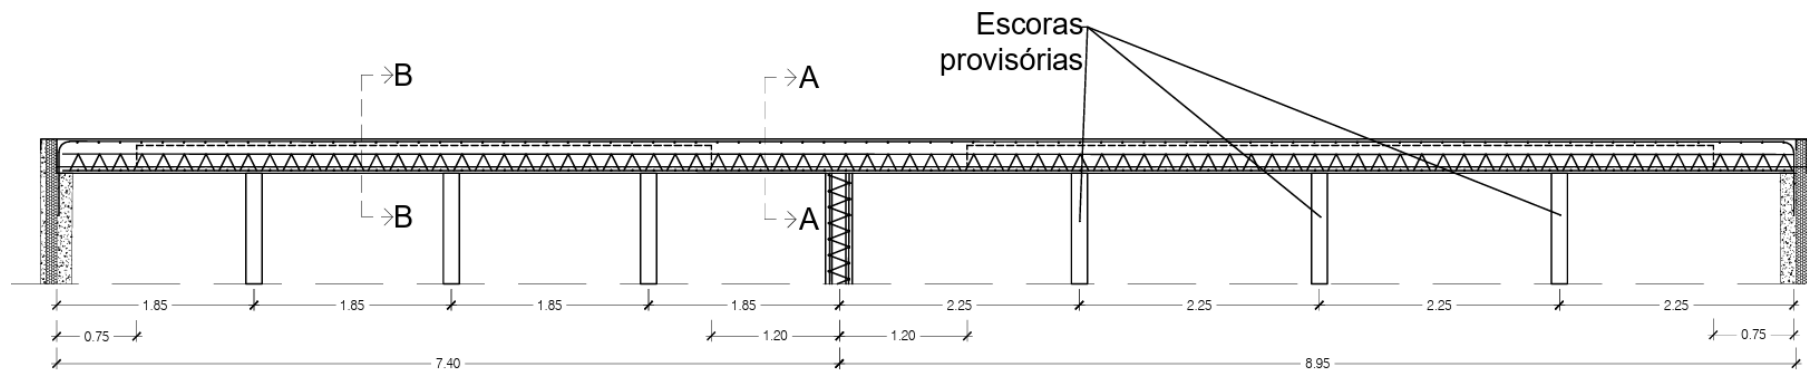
Corte longitudinal da pré-laje aligeirada
